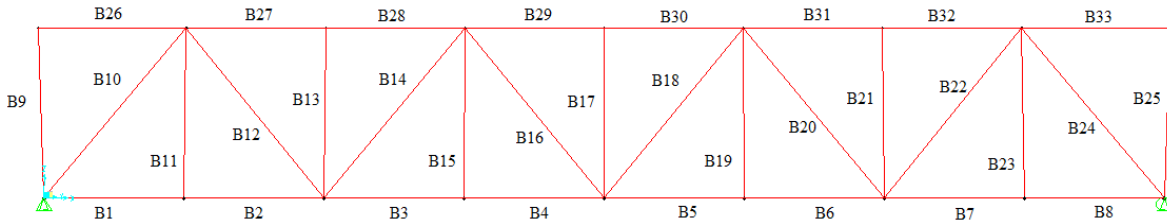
Vista en corte de la armadura en su lado B con numeración de elementos.
